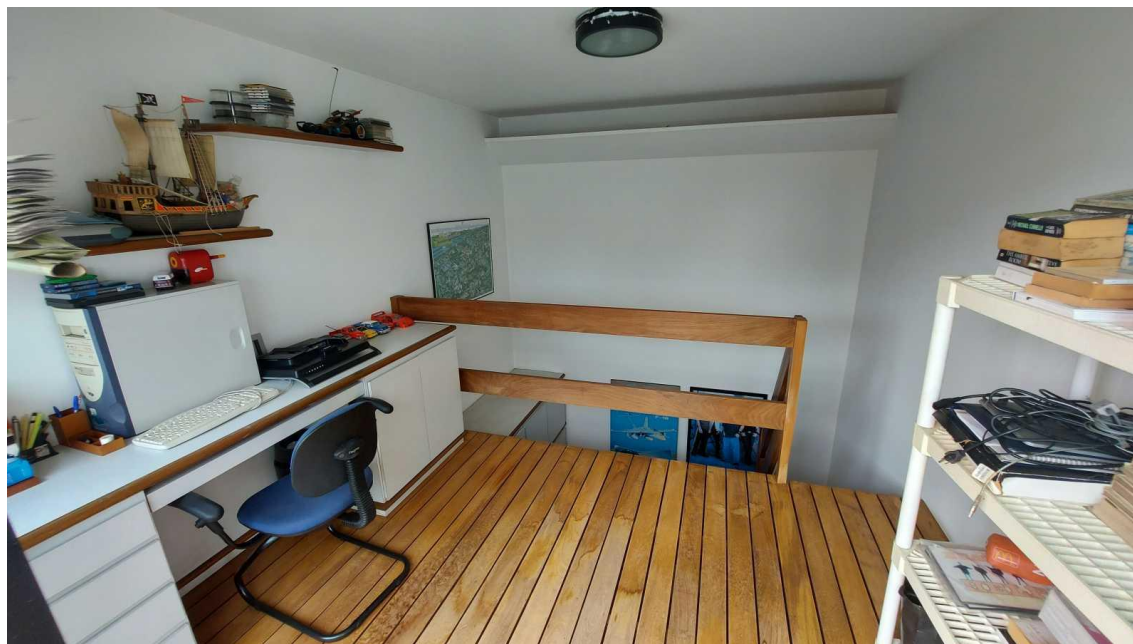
Mezanino do Dormitório 1 - 1º Pavimento
